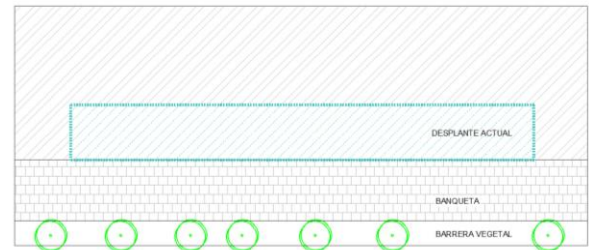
Planta esquemática que indica el área del relingo en planta baja.
